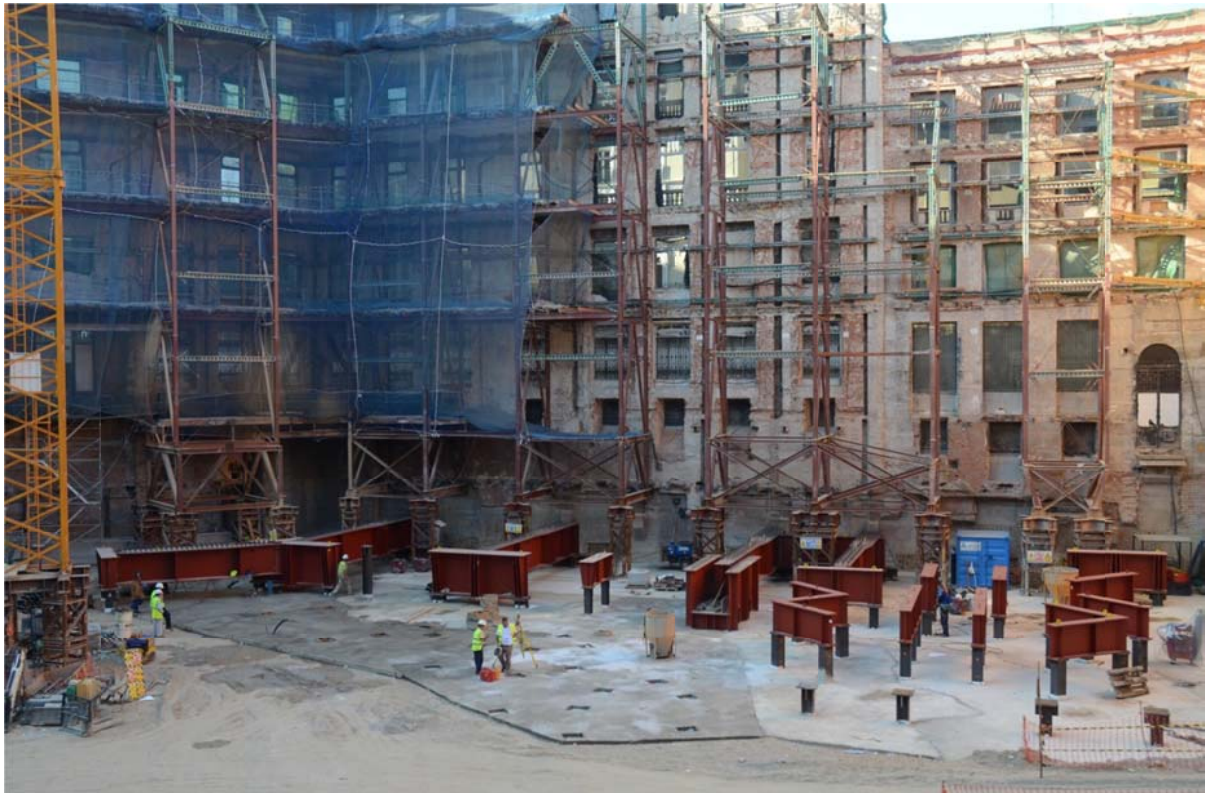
Vista general de la colocación de los encepados y vigas cargadero asociadas a la planta interfaz. Al fondo, las fachadas de la carrera de San Jerónimo y la plaza de Canalejas estabilizadas. Las mallas azules indican los forjados originales apeados.
